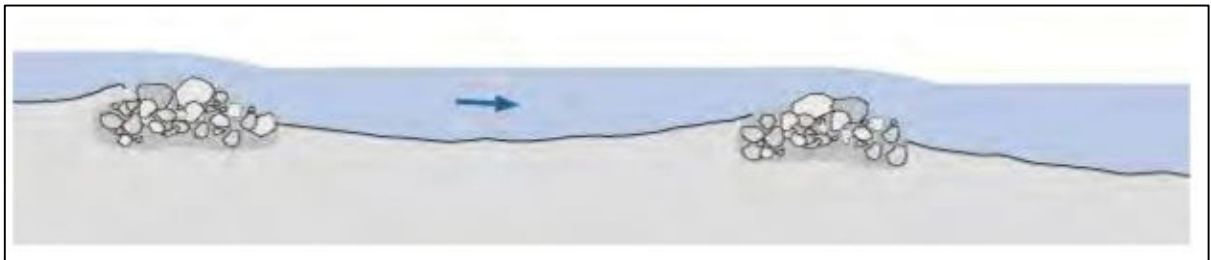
Prinzipskizze einer Stützschwelle im Längsschnitt (DWA, 2014)
